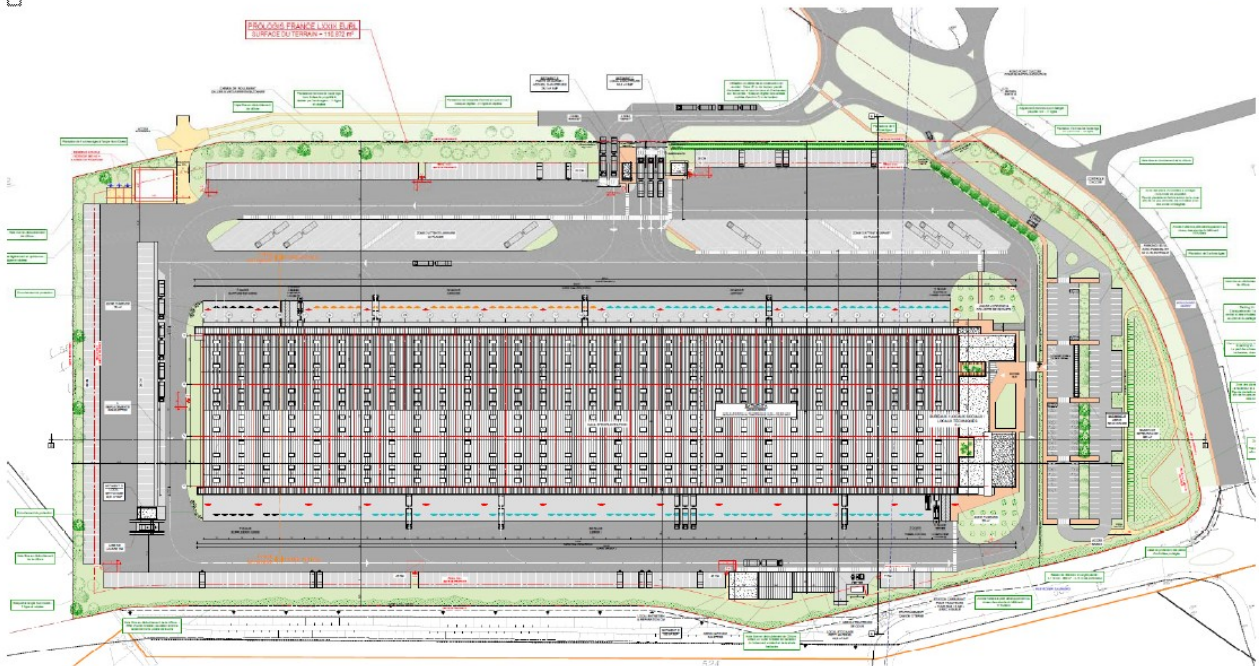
Extrait du plan de masse du projet de messagerie (sans échelle)
